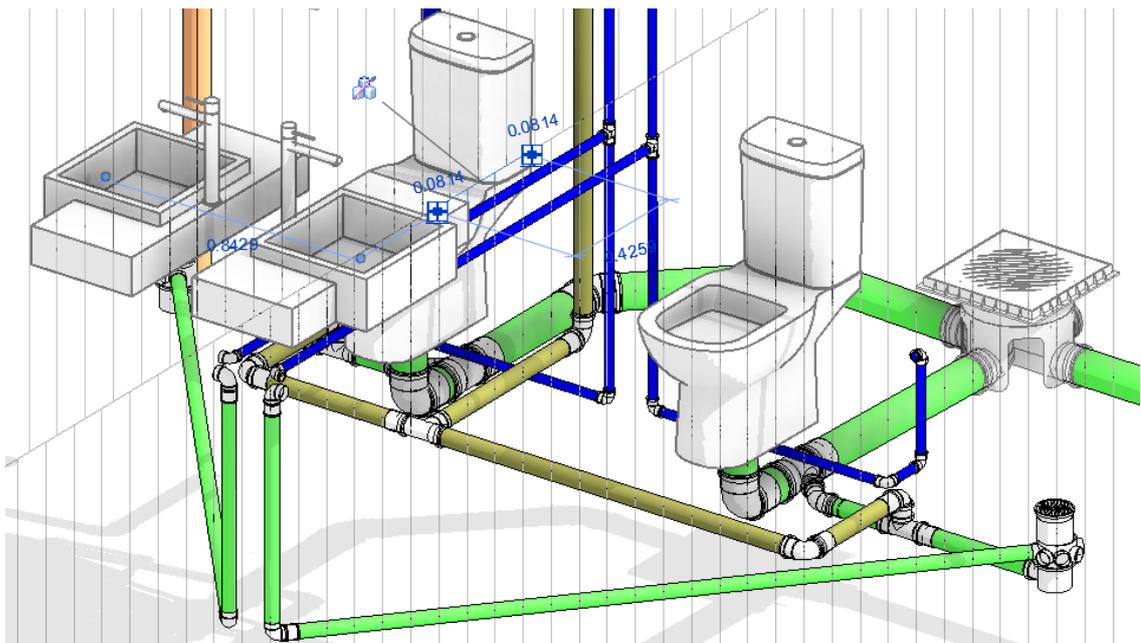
Detalhamento projeto Revit instalações hidráulicas
